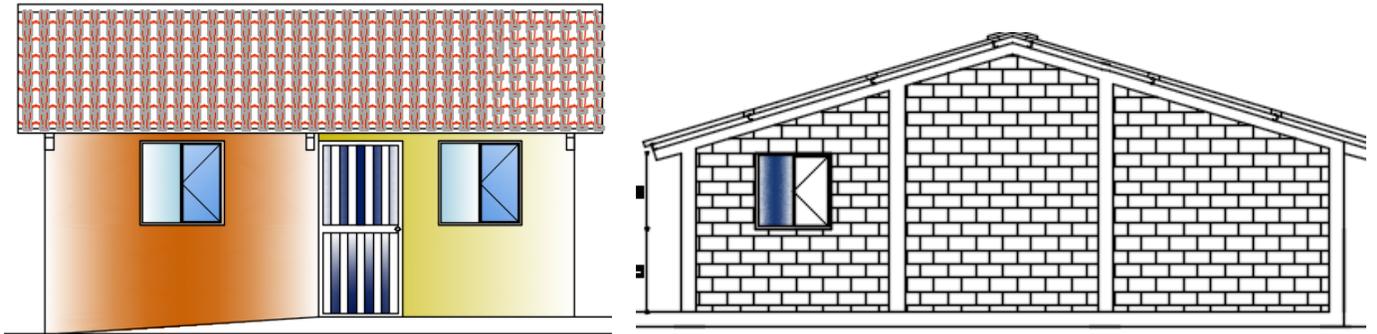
Fachada frontal y lateral vivienda tipo proyecto "Nulti".
